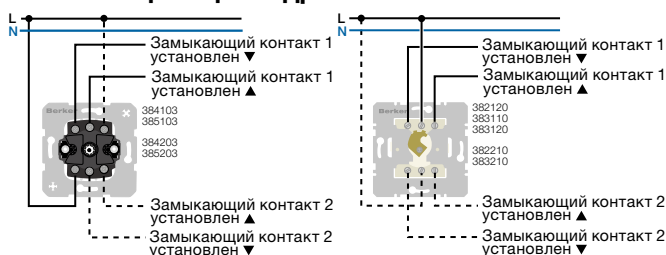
Жалюзиный поворотный выключатель 1- и 2-полюсный [№ для заказа 3841 03, 3842 03]; выключатель жалюзи 1- и 2-полюсный для центральной панели с замком [№ для заказа 3851 03, 3852 03] / выключатель/кнопка жалюзи 1- и 2-полюсный для профильных полуцилиндров [№ для заказа 382..., 383..]
